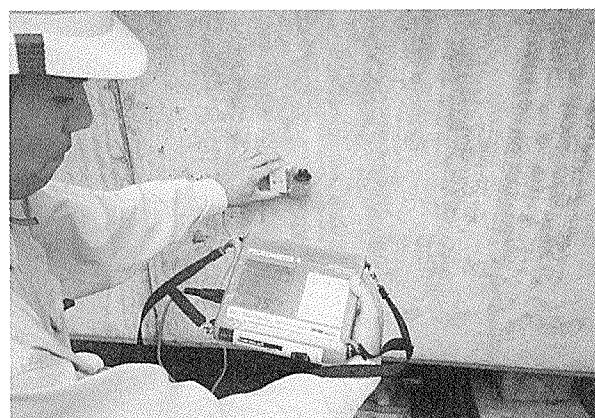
電磁誘導法による鉄筋かぶりの非破壊検査
